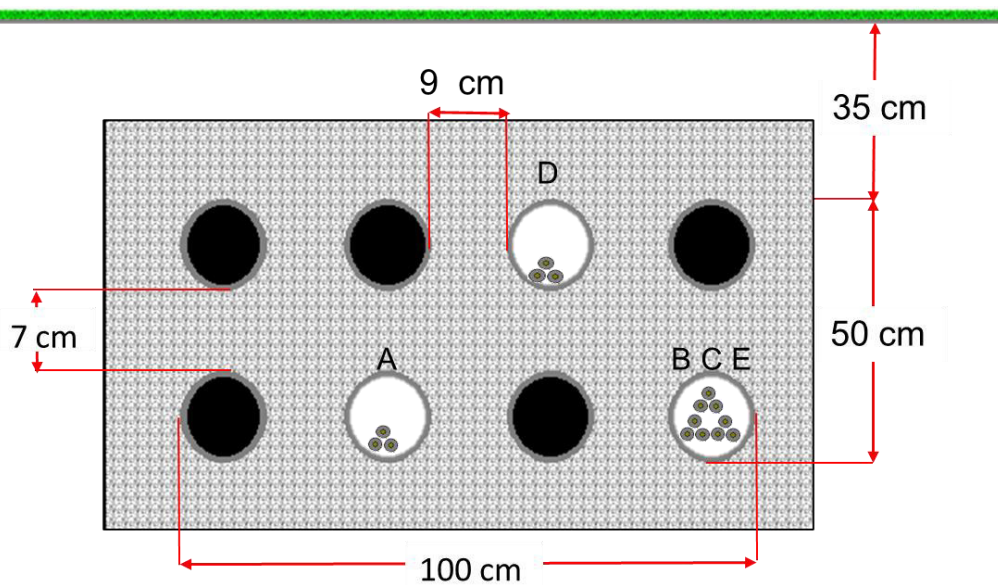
Dimensiones del BD y disposición de los cables de S/E 07
